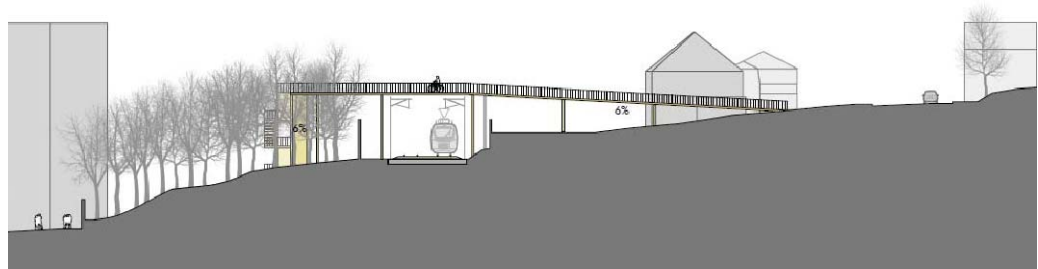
Mögliche Überführung Ruschebach (Quelle: Stadt Baden)
